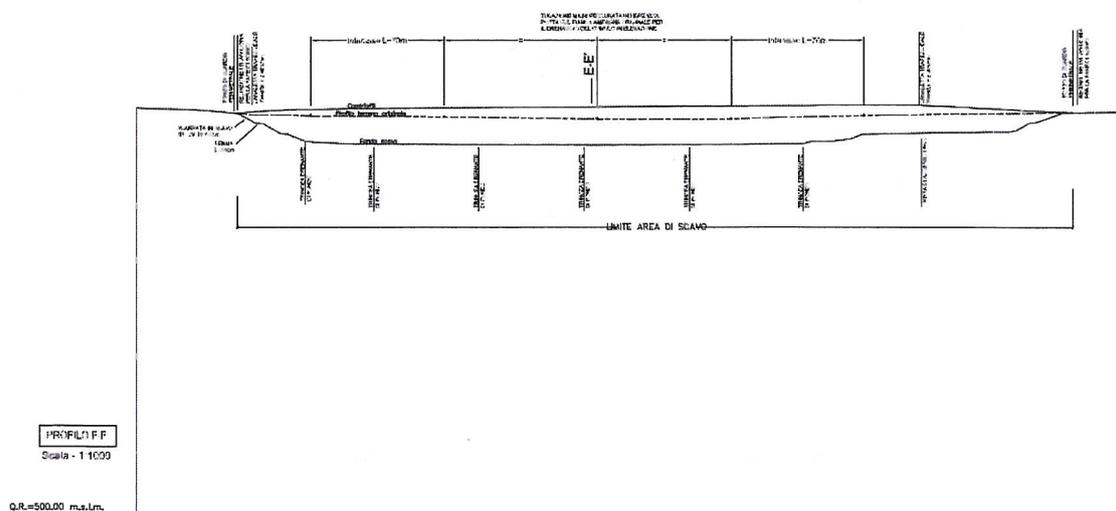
Depositi definitivi in Val Riga – C – Plattner – Sezione trasversale F-F
